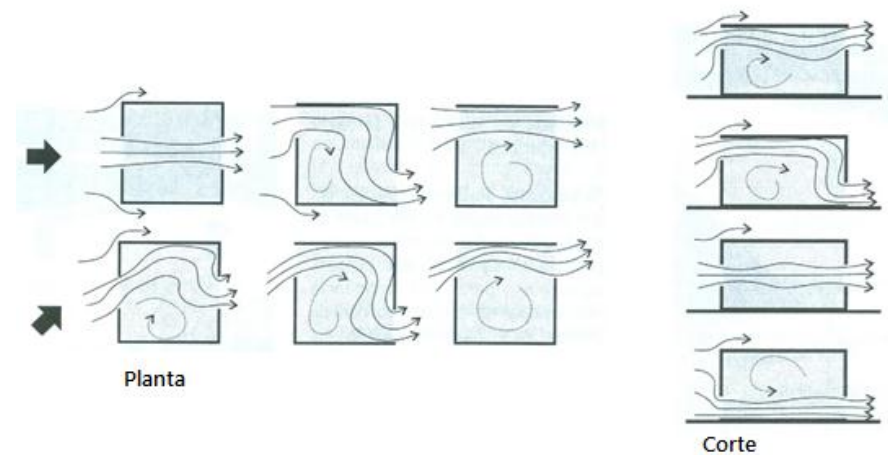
22 – Efeito da localização das aberturas em paredes opostas (em planta e em corte). Fonte: adaptado de Givoni (1976).
